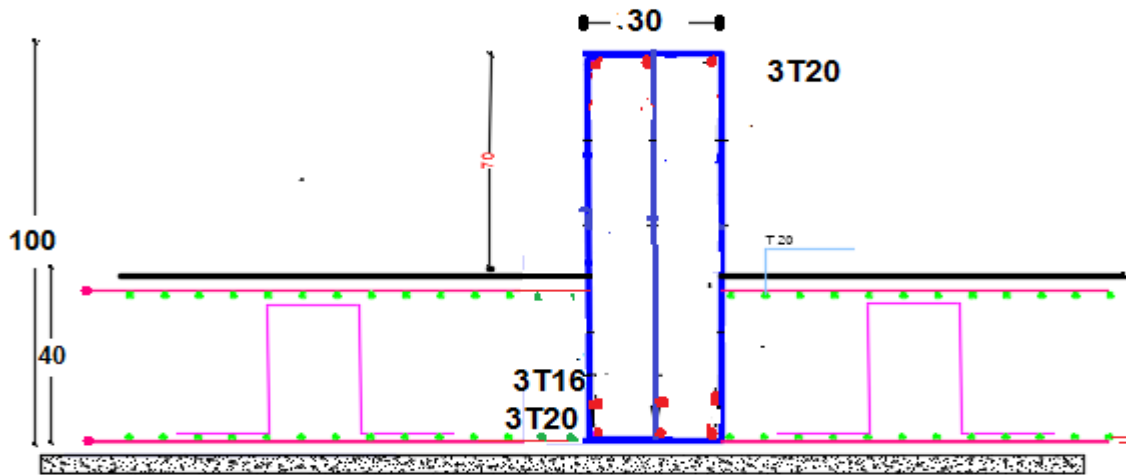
dessin de ferrailage d'une poutre secondaire en travée.
